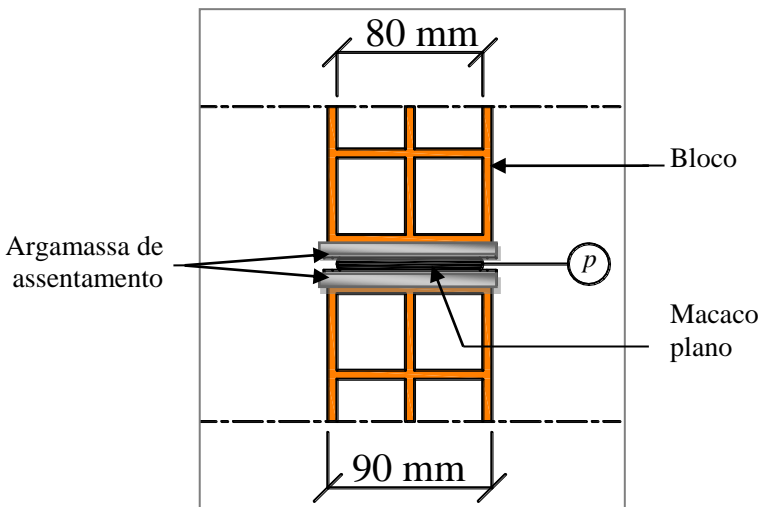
Ensaio B: corte transversal da parede sem revestimento e a inserção do macaco plano
